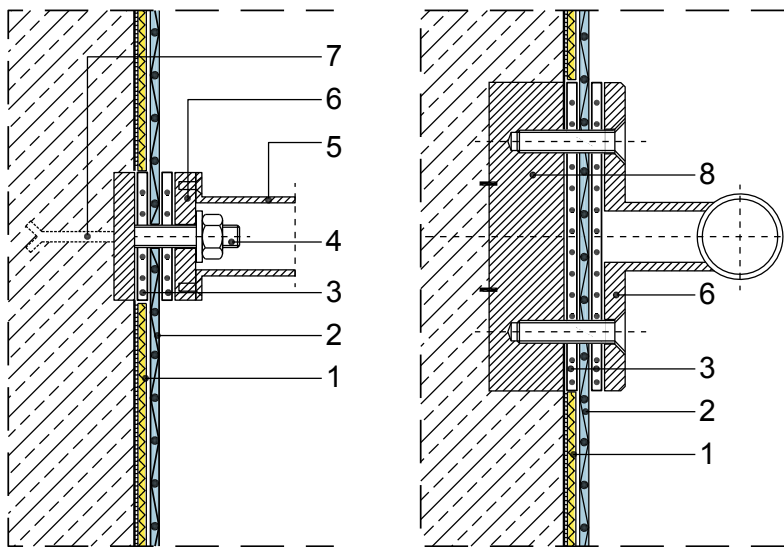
| Los-/Festflanschverbindung mit Ankerhülse
